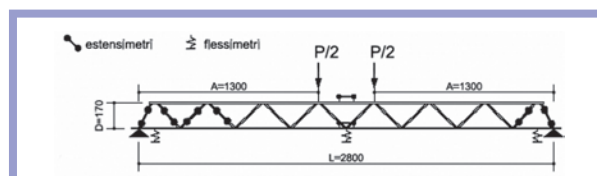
schema di prova e schema statico delle travi per prove a flessione in 1° fase
